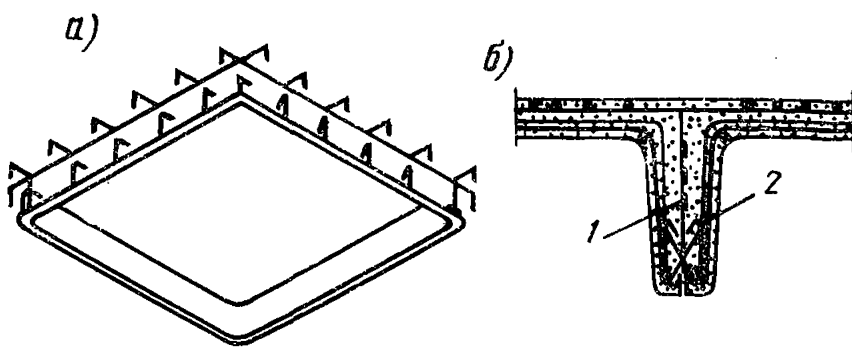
Сборно-монолитные оболочки с использованием несущей железобетонной или армоцементной опалубки
